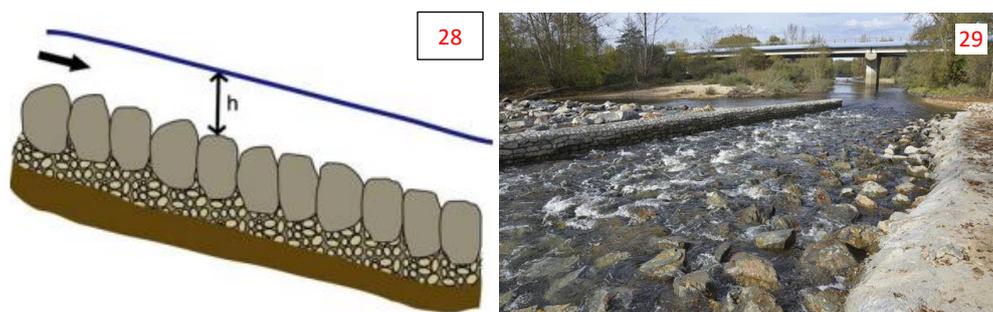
Coupe longitudinale schématique d'une rampe en enrochements jointifs (GHAAPÉ – 2006)
